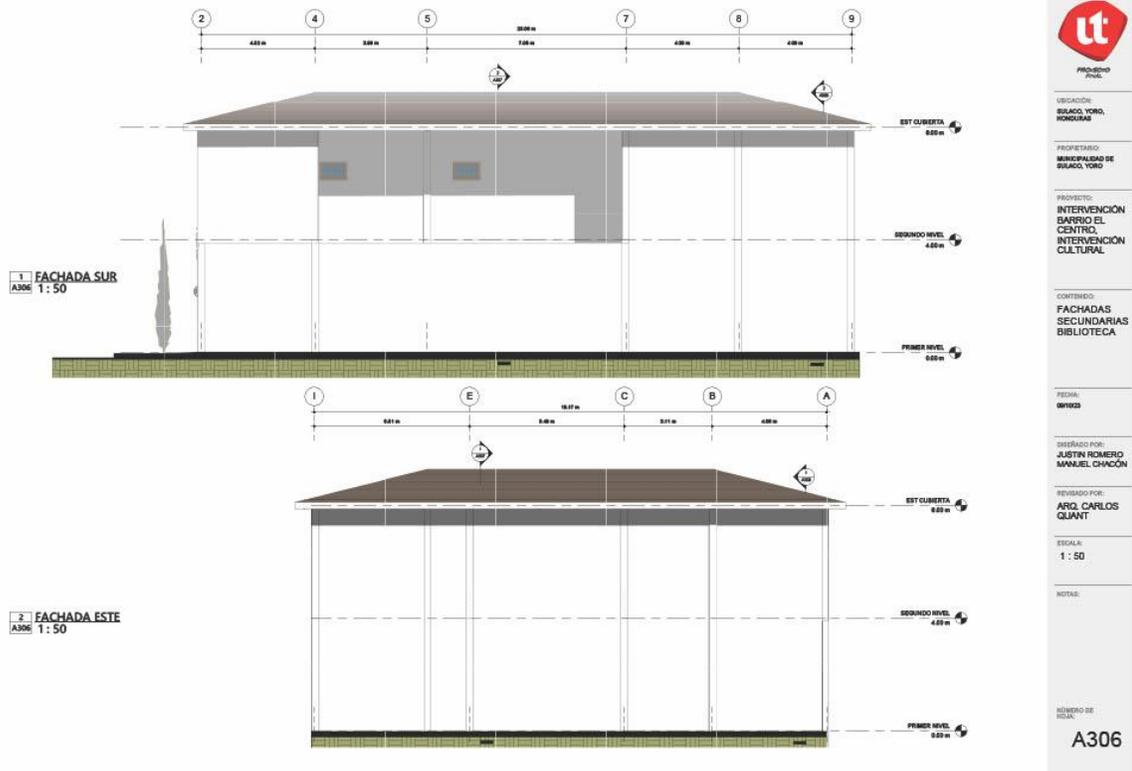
Fachadas Secundarias | Fuente: elaboración Propia
